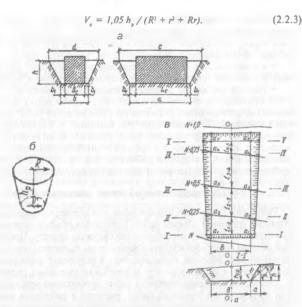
Схемы котлованов для определения объемов работ: а — котлован прямоугольной формы в плане; б — котлован круглой формы в плане; в план и разрез котлована к подсчету объемов методом поперечных сечений.
